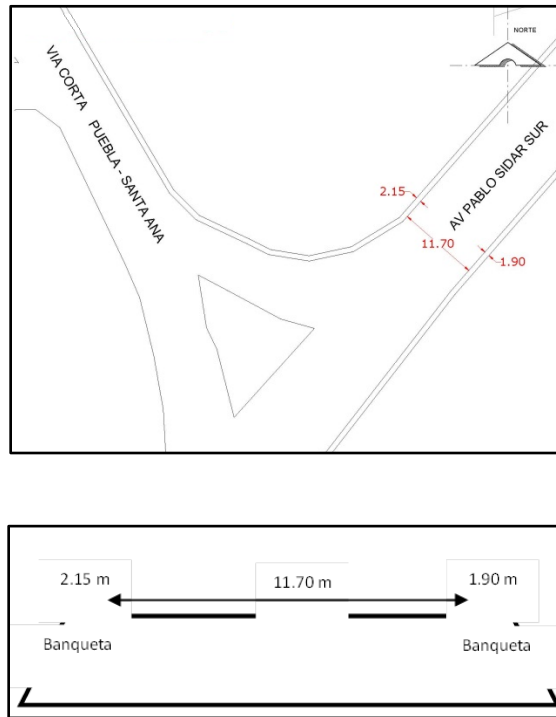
Banqueta sobre Pablo Sidar Sur
